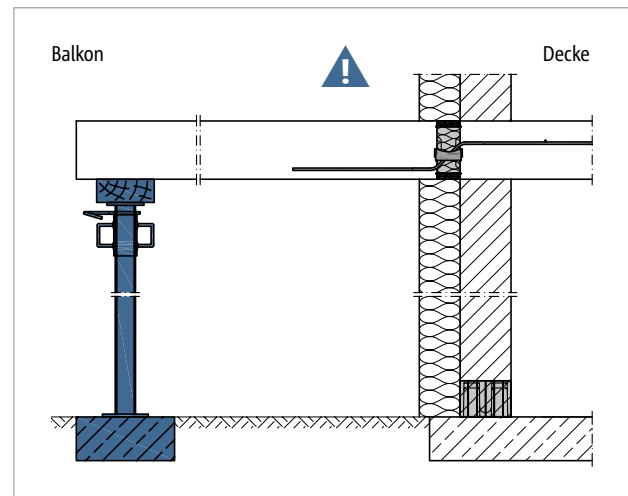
Schöck Isokorb® T Typ Q: Stützung durchgängig erforderlich
